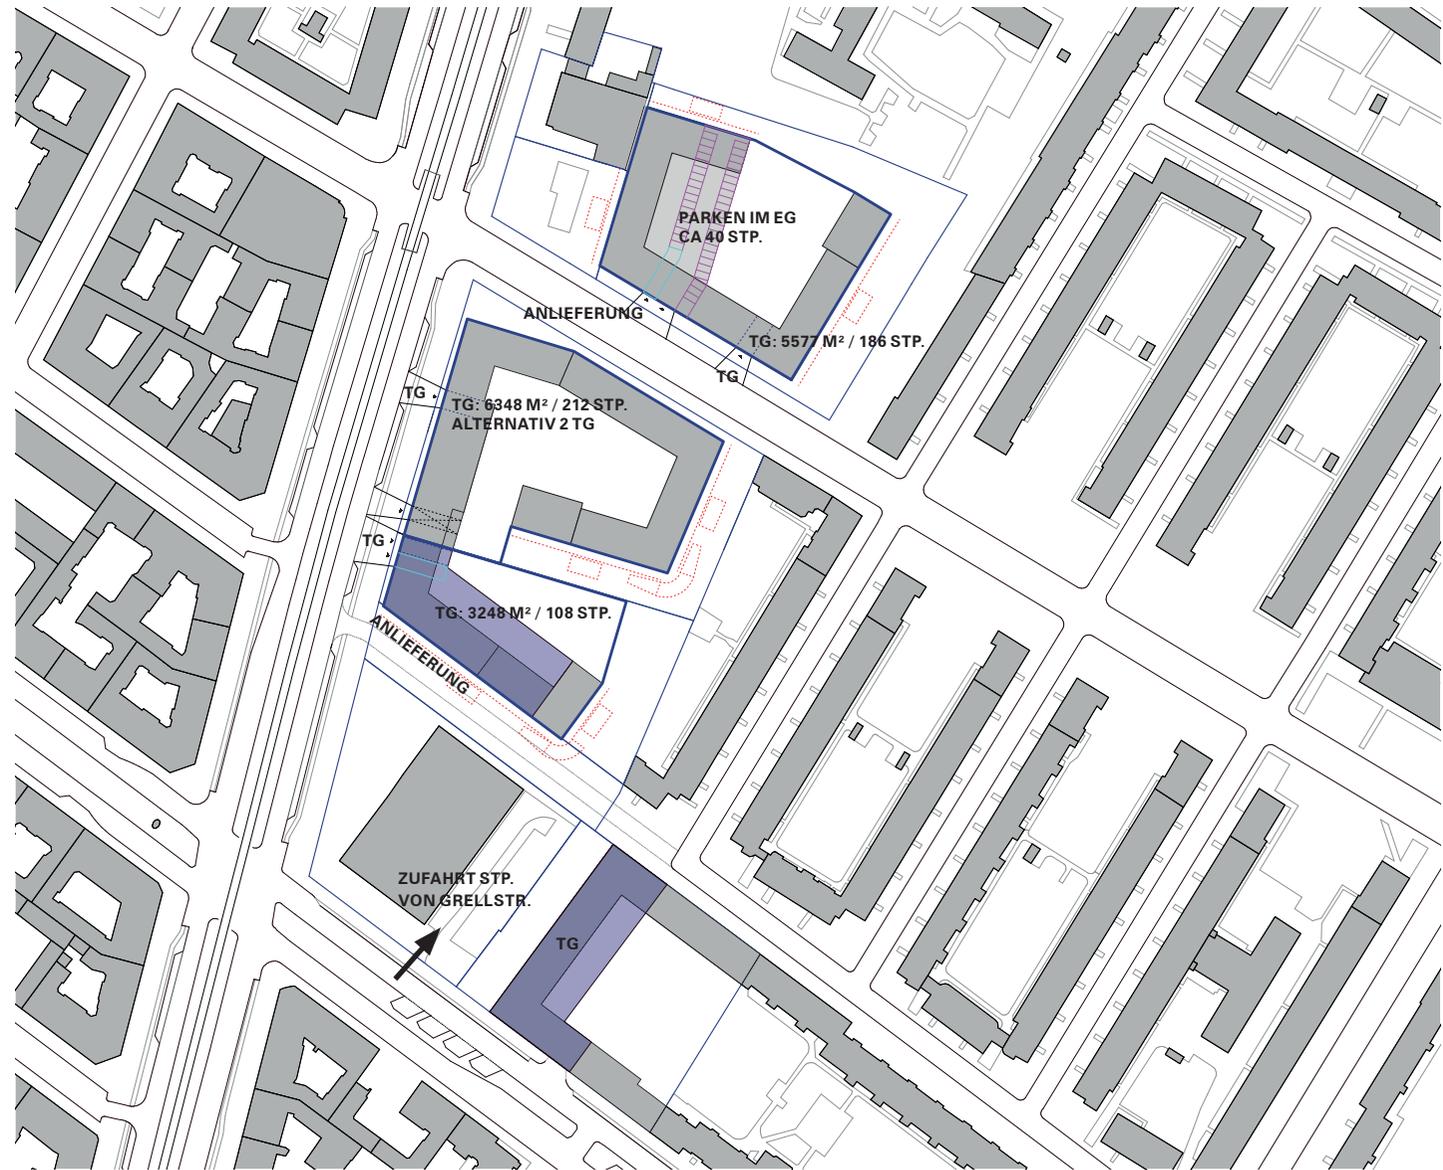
Variante A, Anlieferung und Parkierung, o. M.
